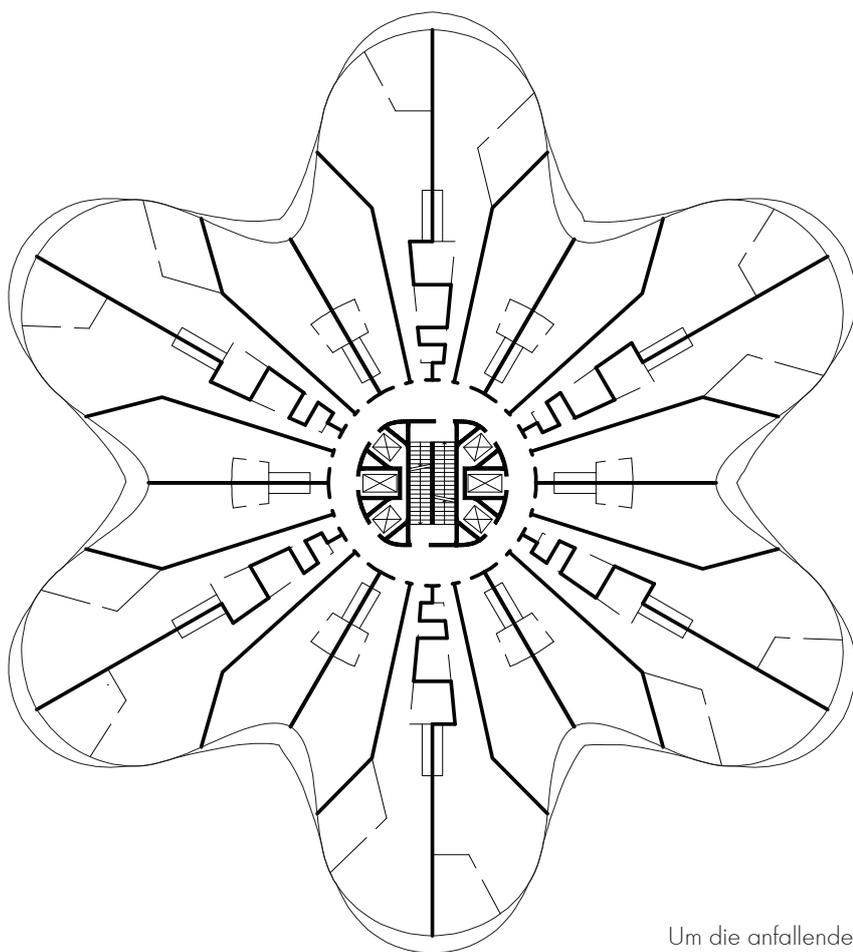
Grundriss Hôtel Saint-James, Jean Nouvel
